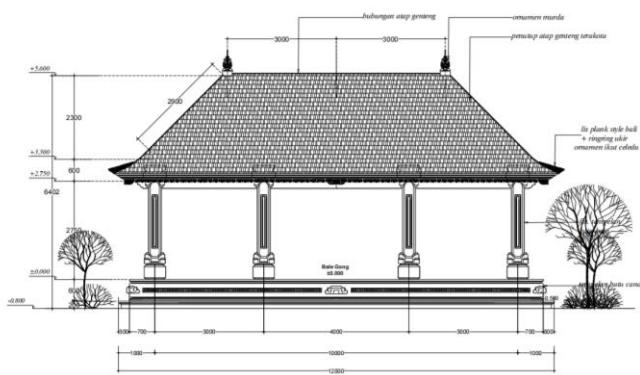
, Rancangan Pengembangan Infrastruktur Pura/Masterplan
